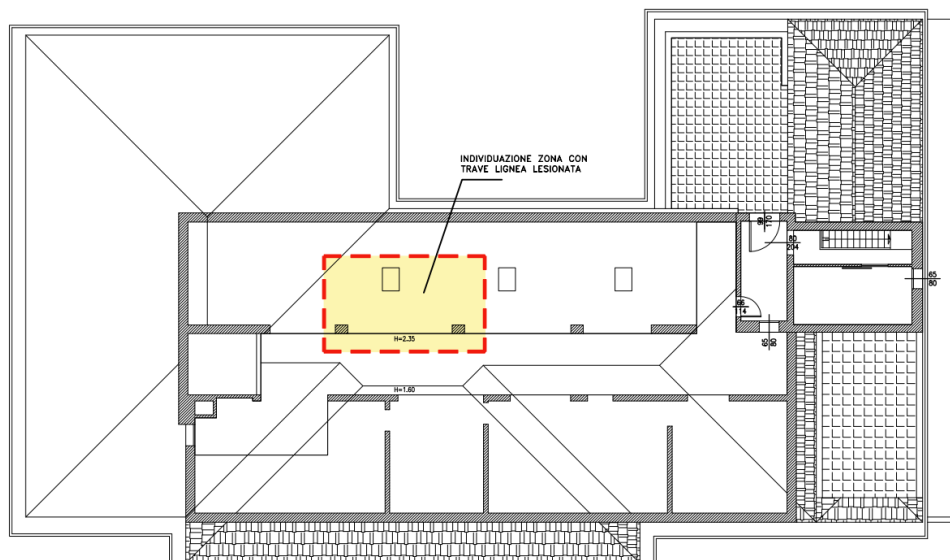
Pianta sottotetto con localizzazione dell'elemento ligneo lesionato
